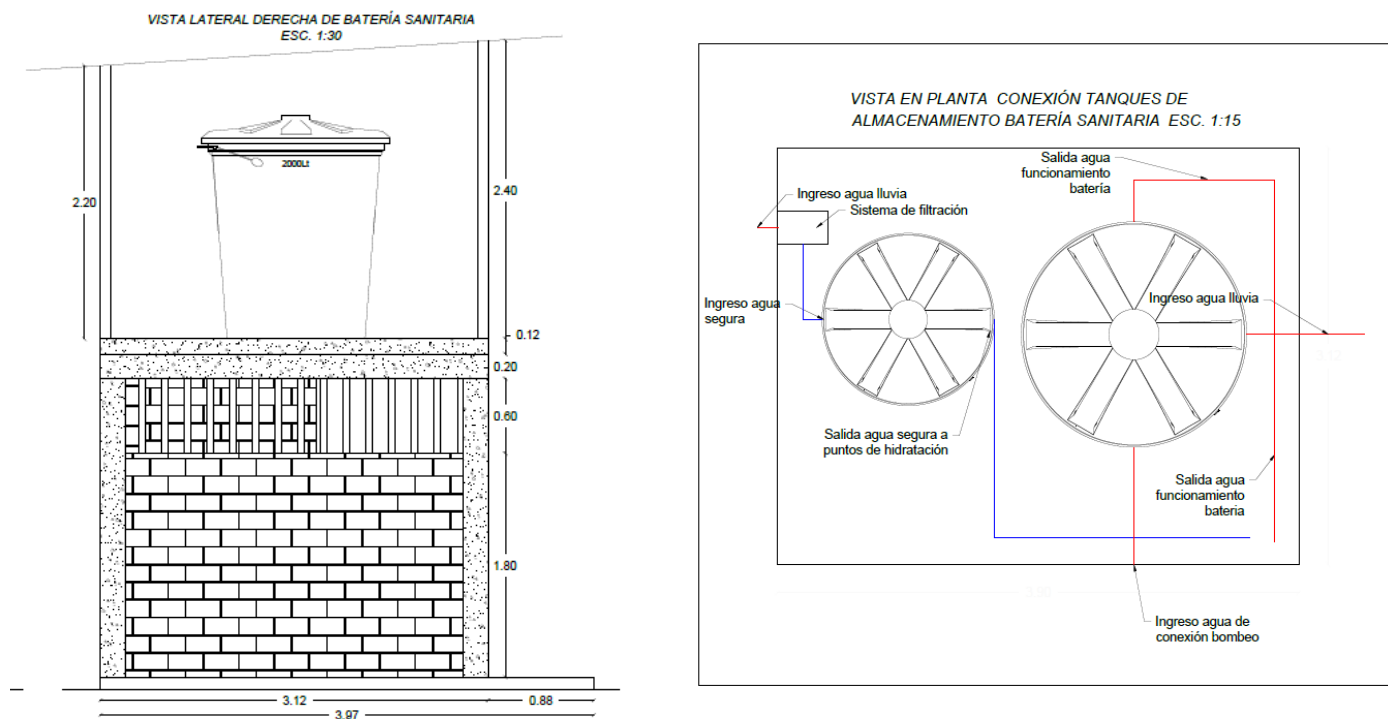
Plano vista lateral derecha y conexiones de tanques de almacenamiento batería sanitaria Casa Cabildo
